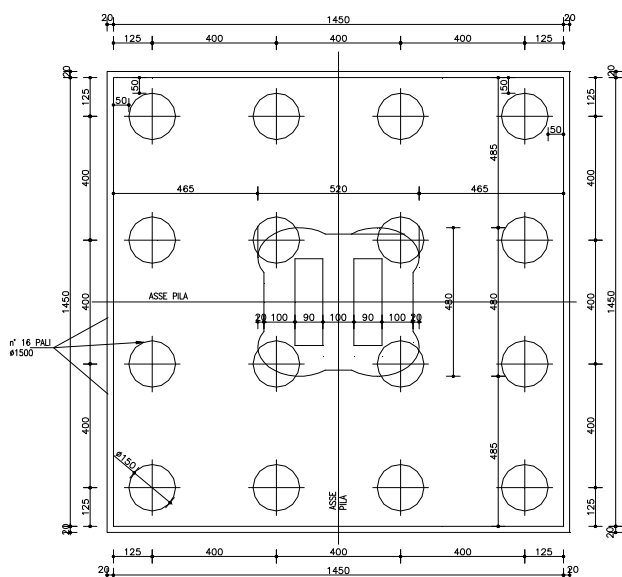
Pianta fondazione pila – Progetto Definitivo
